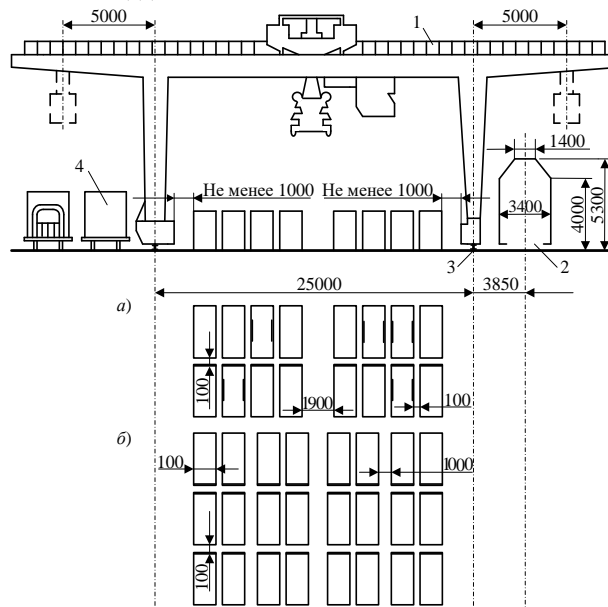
Схемы размещения крупнотоннажных контейнеров на площадке и комплексной механизации с одним железнодорожным путем:
